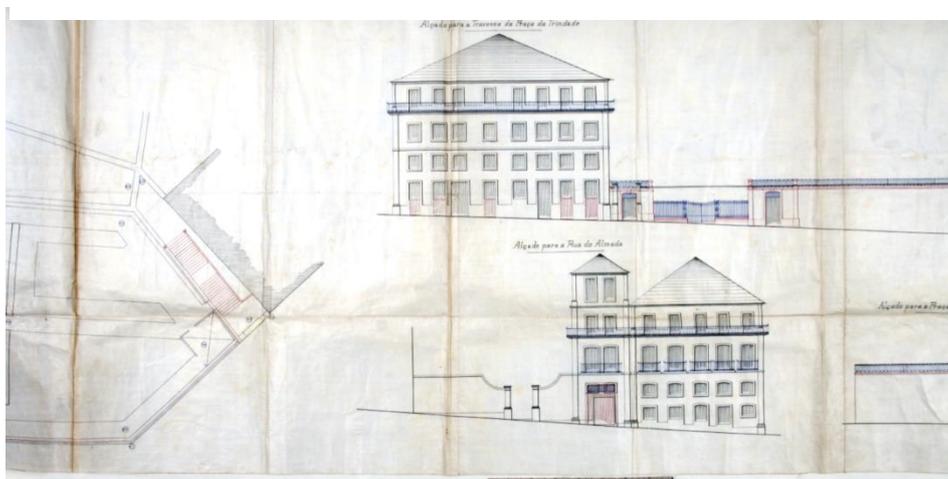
Vista para as fachadas da Travessa da Trindade e Rua do Almada
